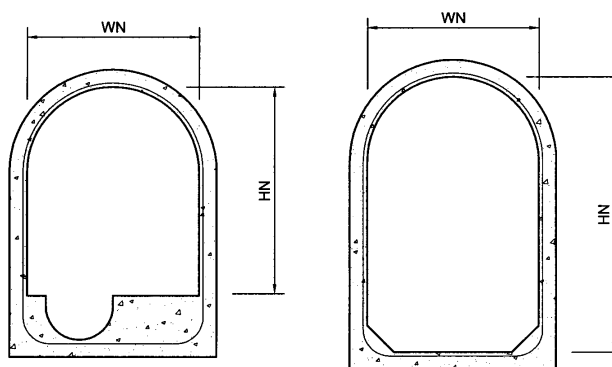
Galerías abovedadas de hormigón armado con andén o sin él
